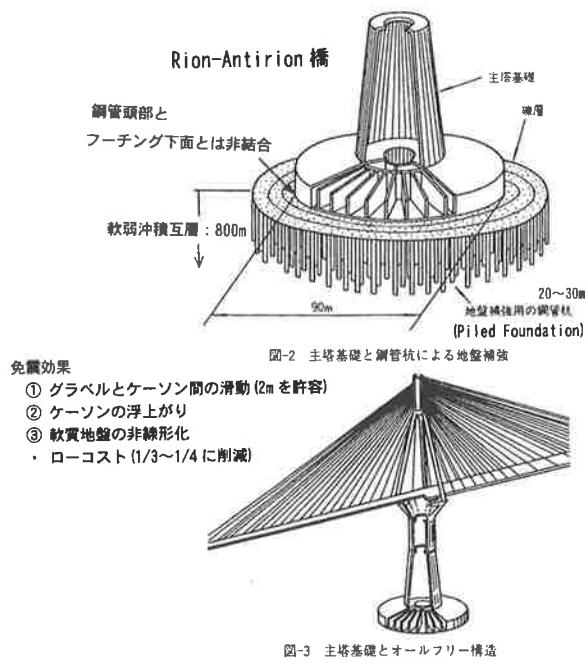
Rion-Antirion橋の基礎：鋼管杭地盤補強+グラベル（Piled Foundation）⁴⁶⁾
